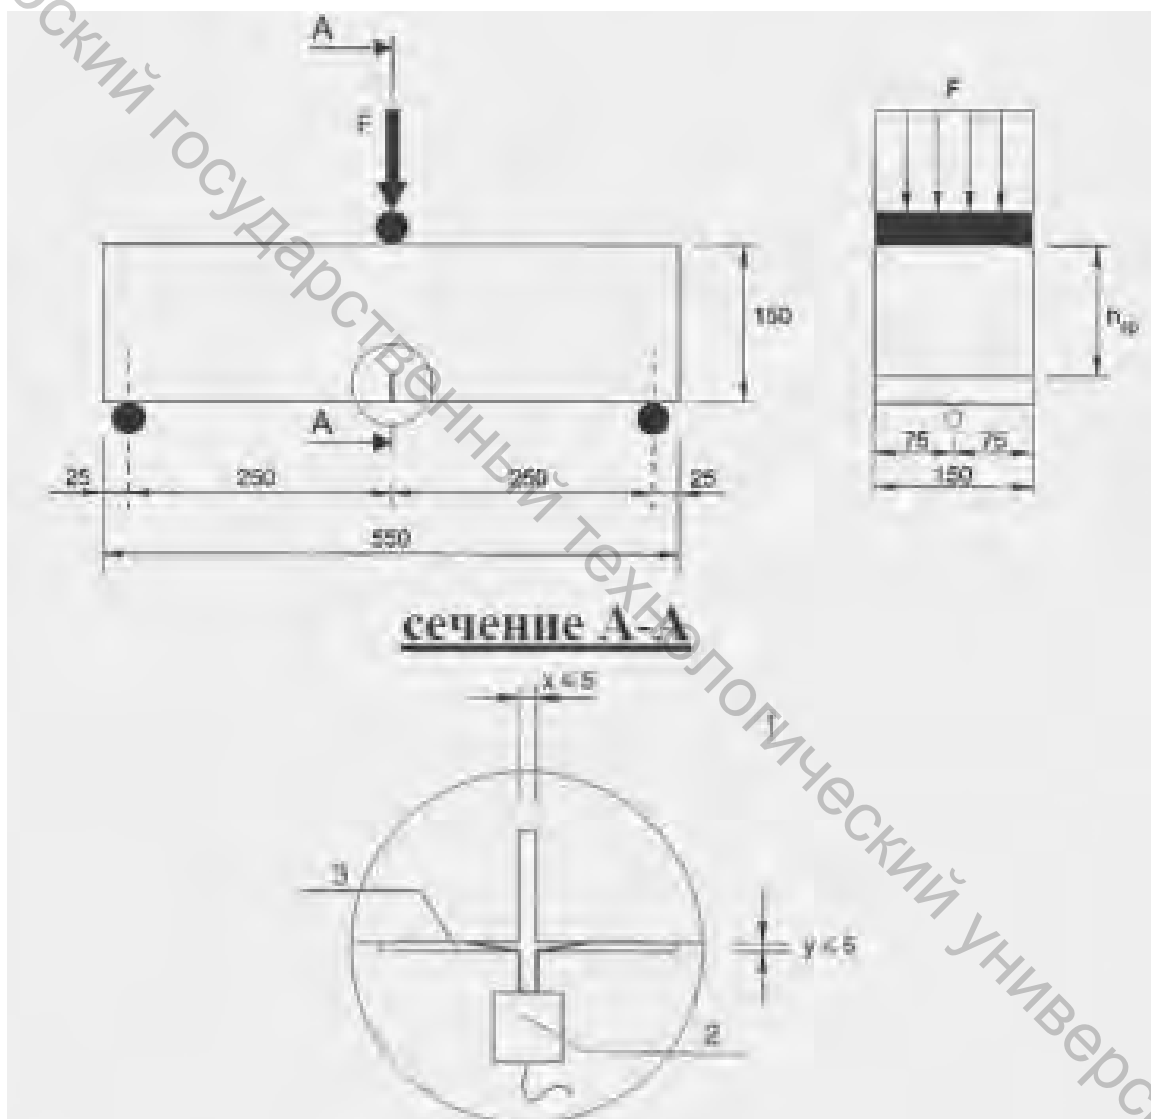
Стандартное расположение образца для измерения CMOD: 1 – деталь (надрез); 2 – датчик (зажимной); 3 – ребро призмы
